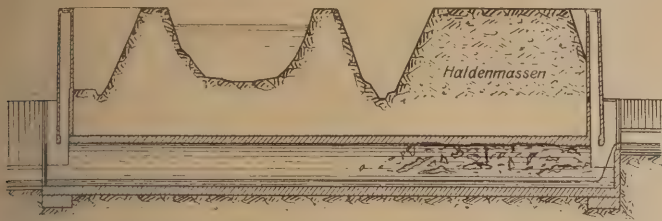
Der Landwehrbachdurchlaß unter dem Rhein-Herne-Kanal
